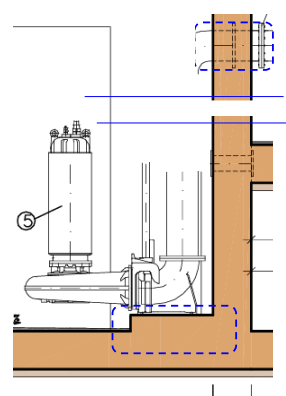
Detalle recrecido para pie de bomba y pasamuro
